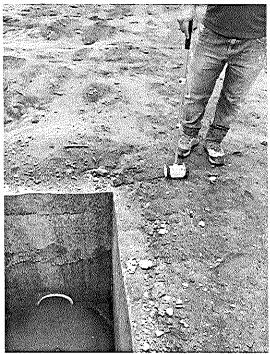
y 16. Estructuras de entrada y tuberías de acceso
